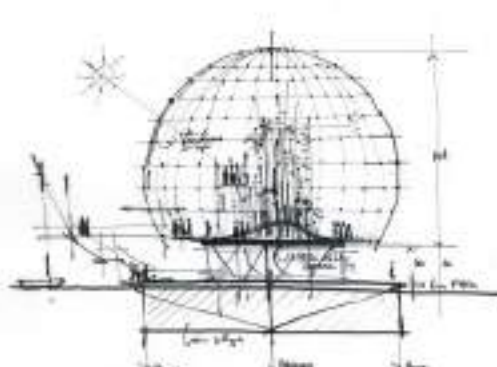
Esquisso de “La Sfera” de Renzo Piano de 17/09/2000. Fonte: Fondazione Renzo Piano
